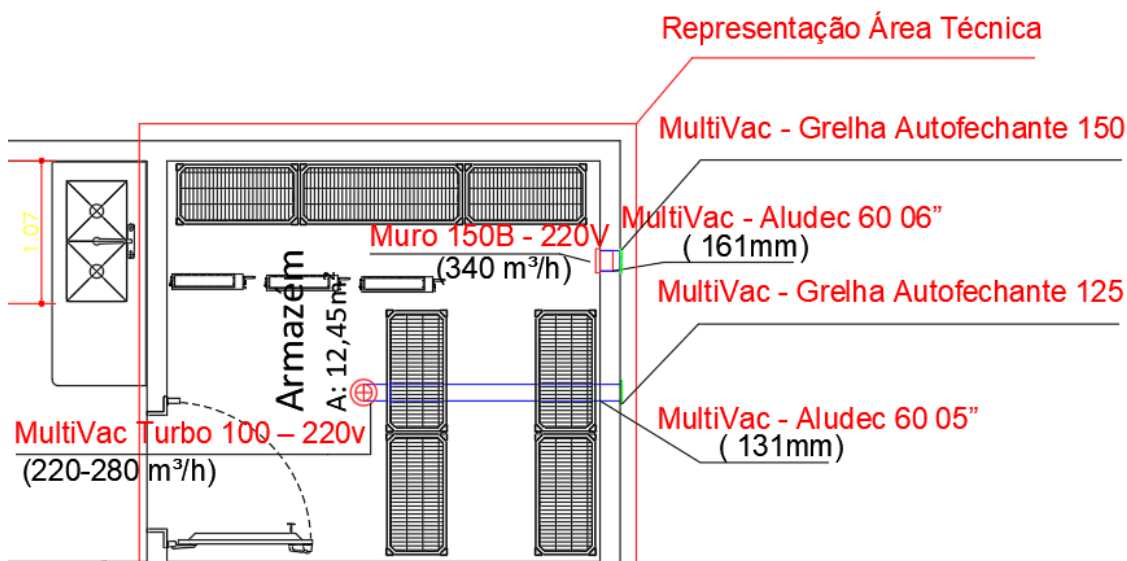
Planta baixa do Armazém – Sistema de exaustão
